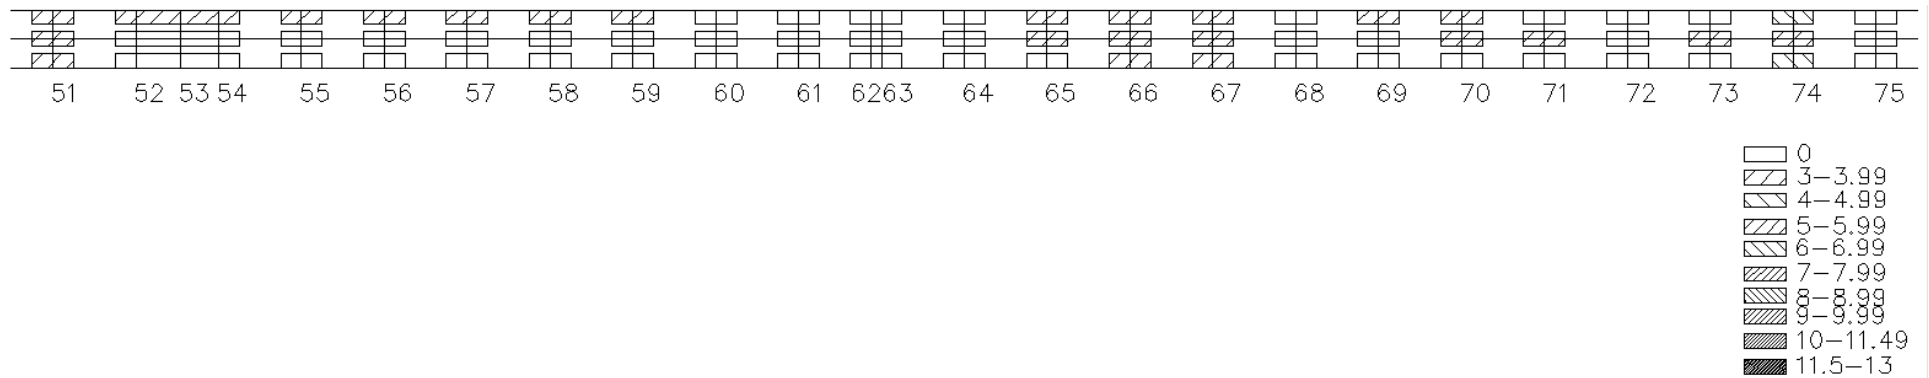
Ausgleichungsdicke bei kubischer Splinefunktion und Verfahrensplan Typ V, Grundriss, Stationen 51-75
